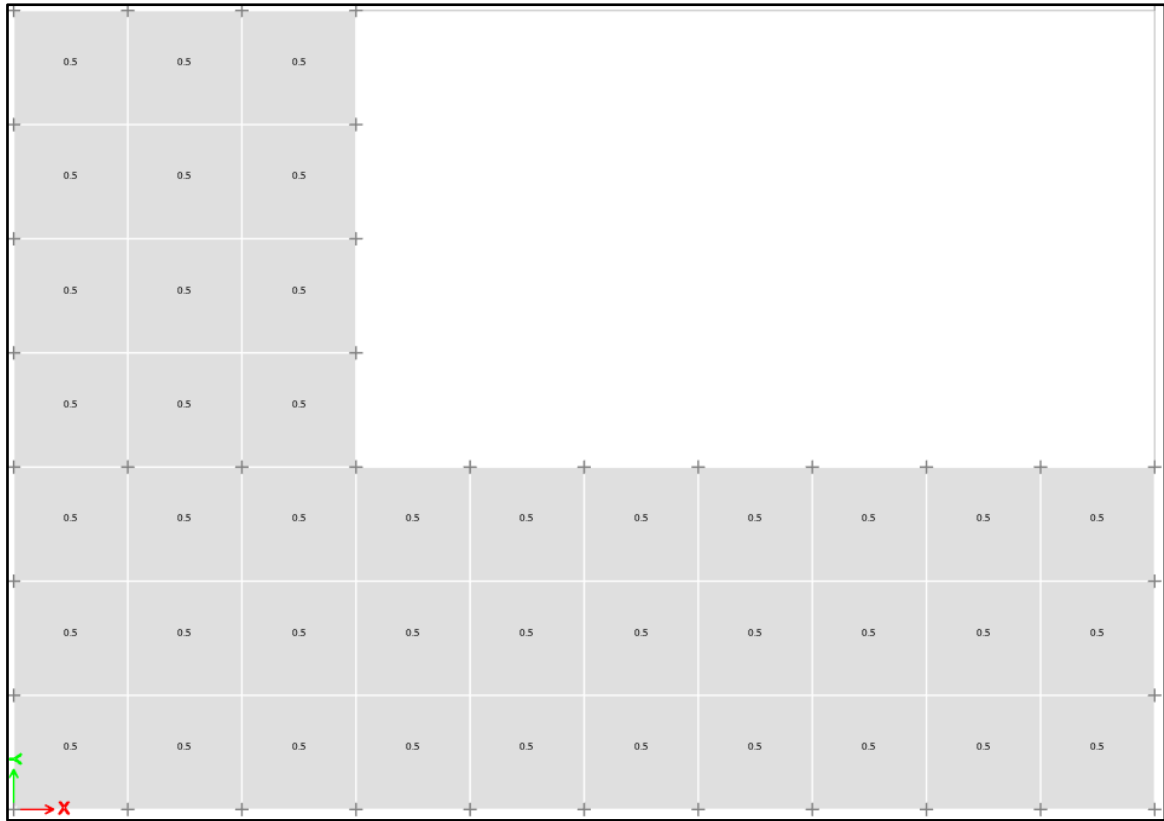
Carga viga sobre la losa maciza (Fuente propia)
